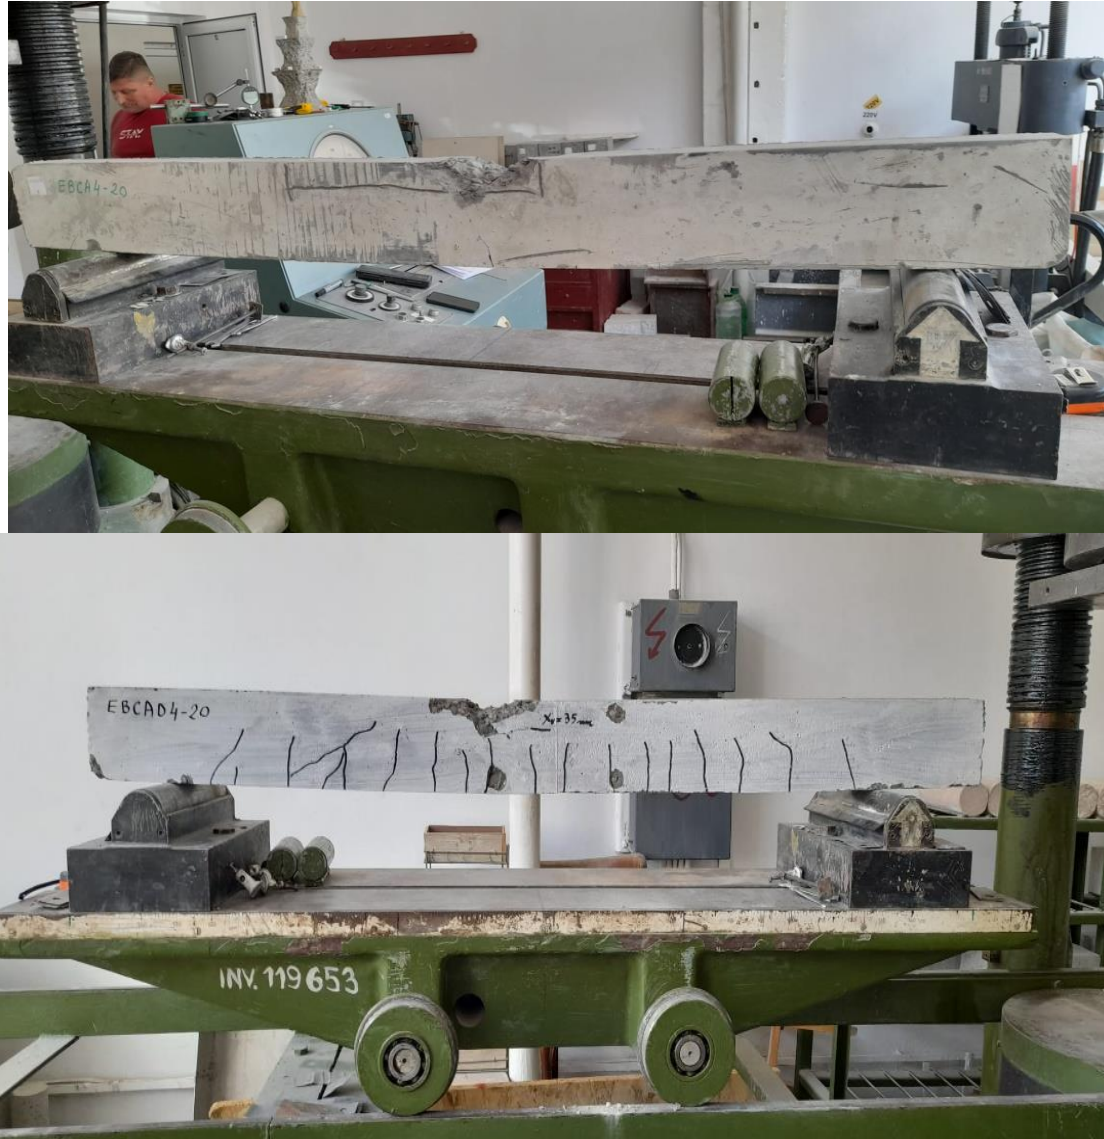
Distribuția fisurilor și modul de cedare grindă armată beton EBCAD420
